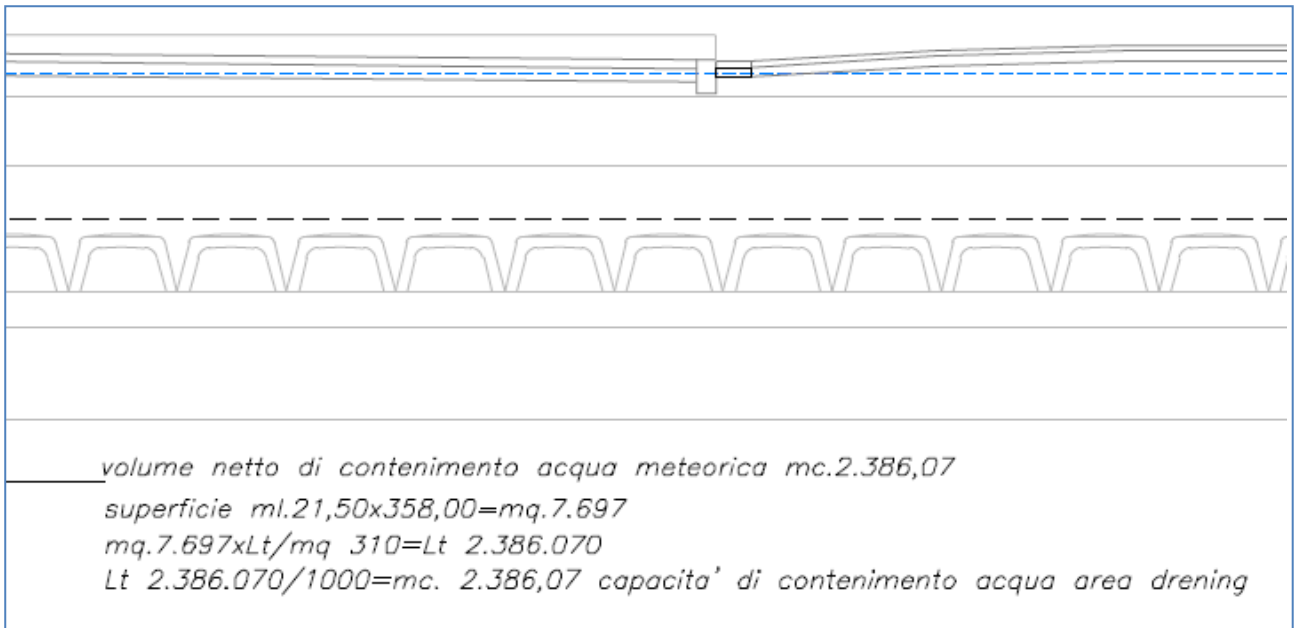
Sezione tipo di parcheggio con drening (particolare con indicazione delle volumetrie da invasare)
